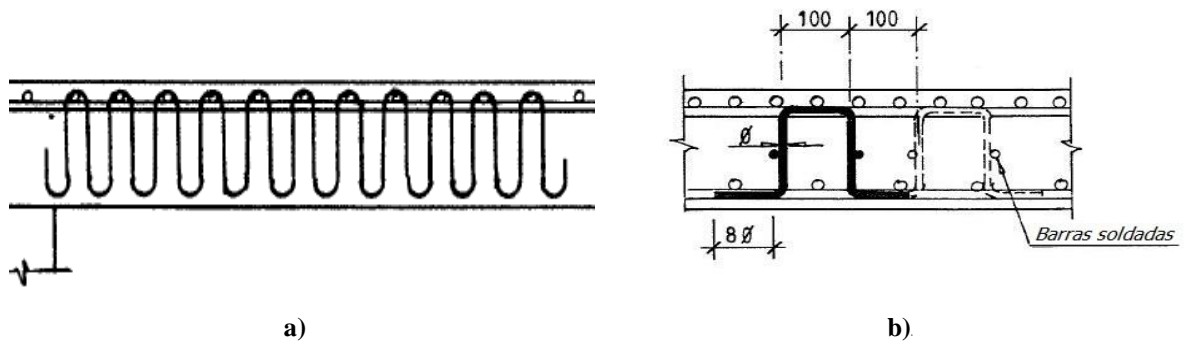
Armadura externa tipo estribo fechado convencional.
